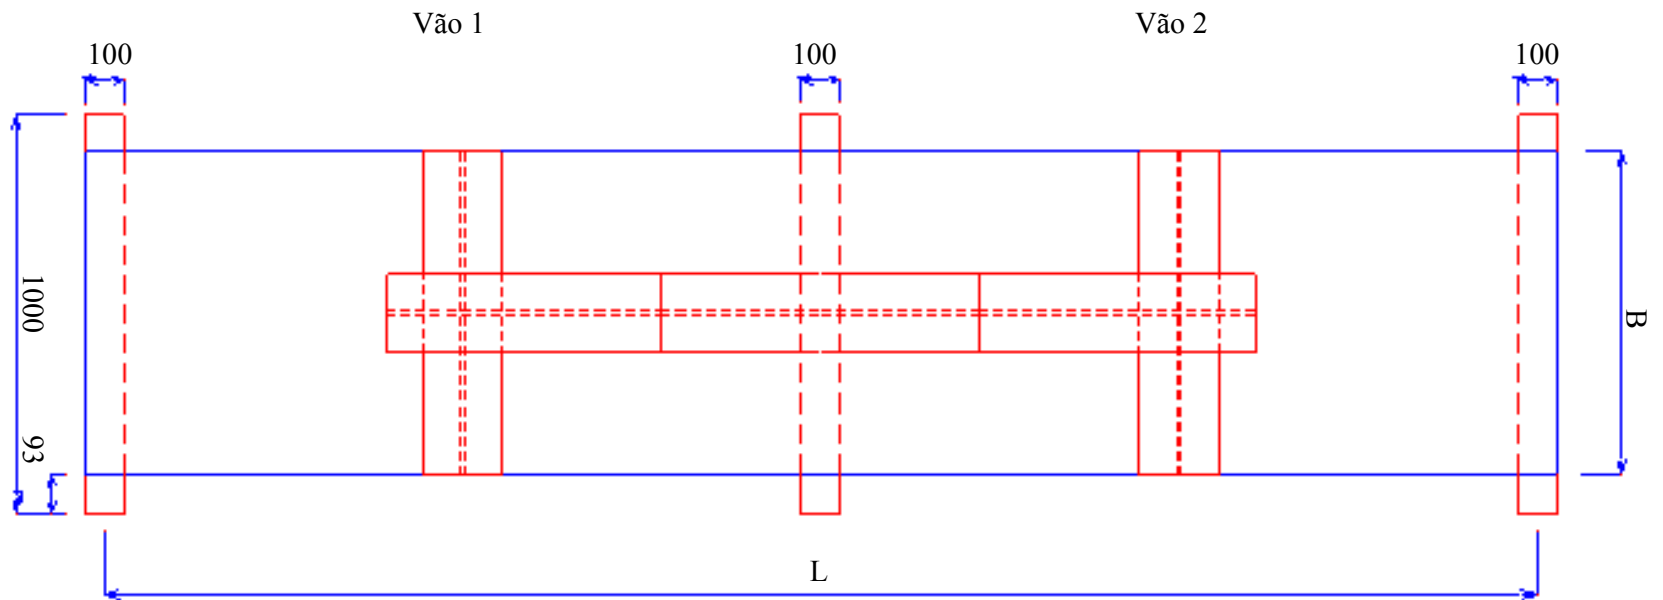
Aparato de carga utilizado nos ensaios da série 2B (medidas em mm) – Vista em Planta
